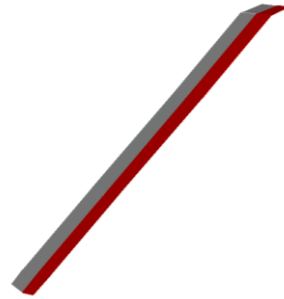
Modelo 3D del pavimento de la pasarela. (Fuente: AutoCAD).
